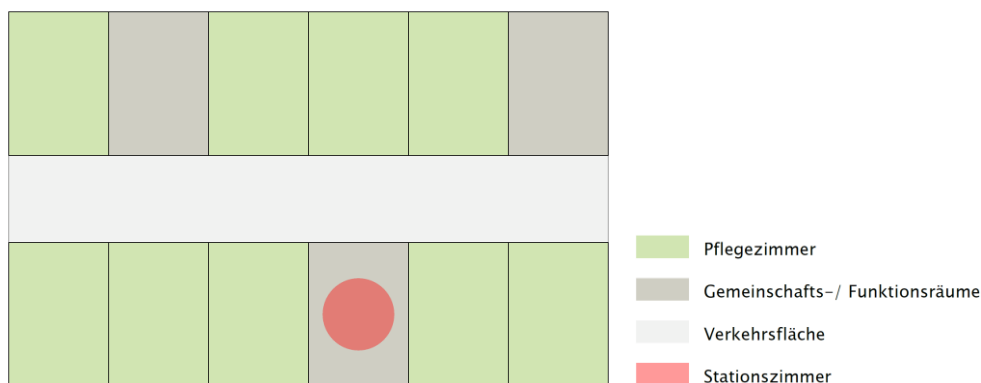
Linearer Grundriss mit einem Korridor
